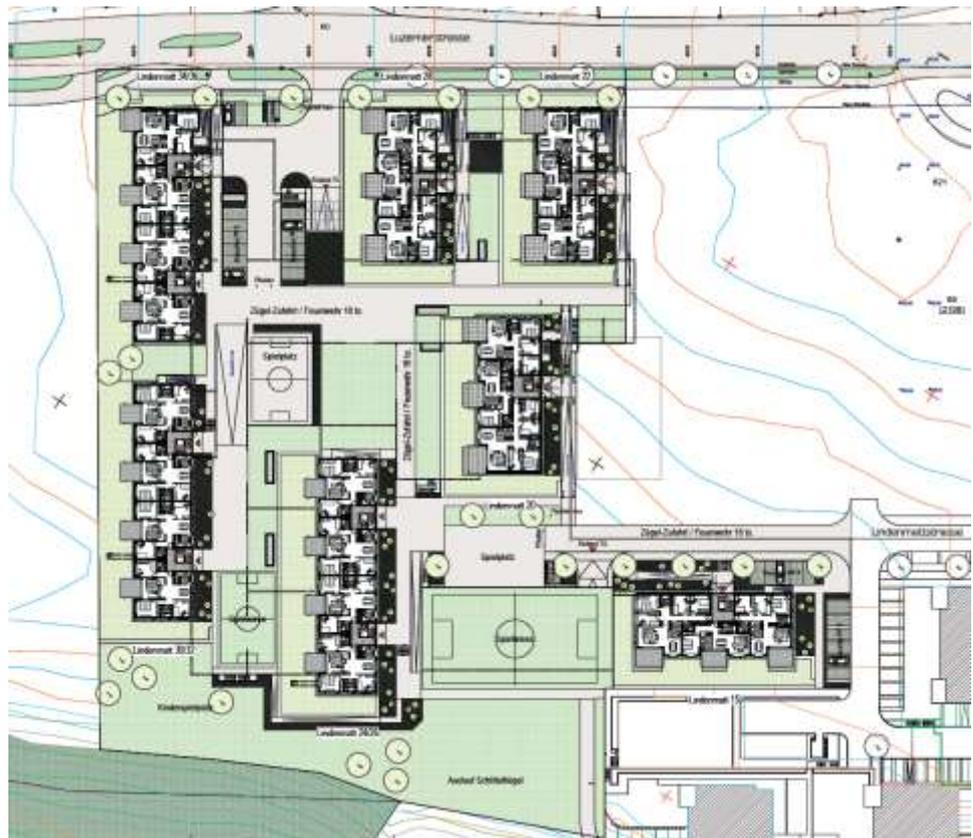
rechtsgültiger Arealbebauungsplan Lindenmatt II (21.11.2008)
